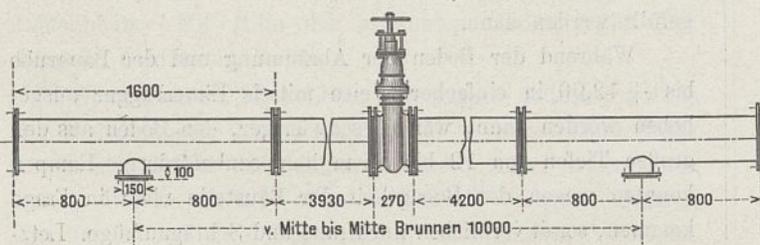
Mit Schieber und ohne Pumpenanschluß.
